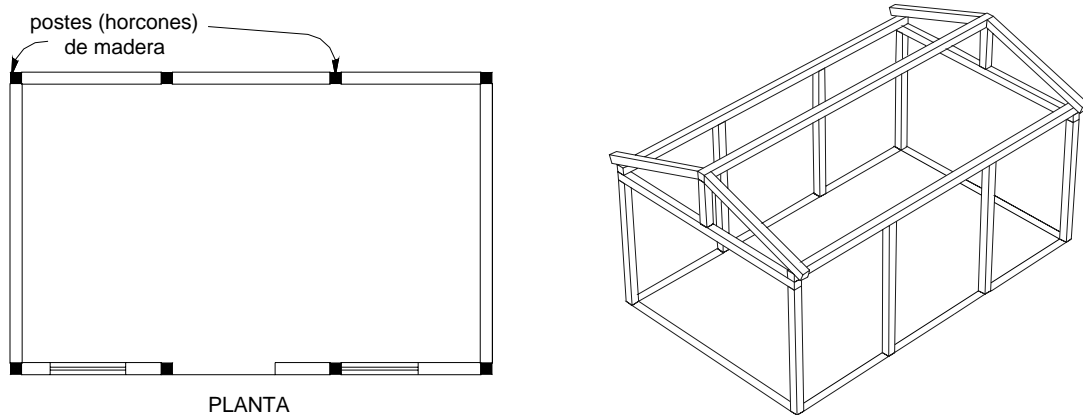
Planta y estructura de madera de un tipo de vivienda usado en Tecomán, Col.
